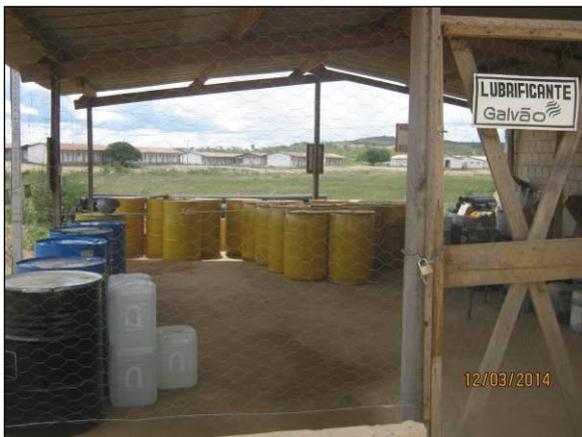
Lubrificantes acondicionados em local com cobertura, piso impermeável, ventilado e sinalizado (mar/2014).
